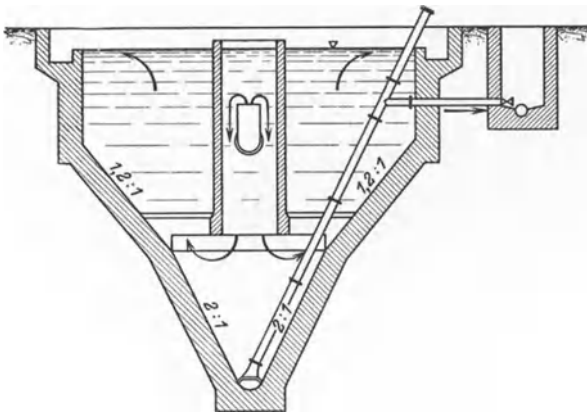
Dortmunder Brunnen für belebten Schlamm.
